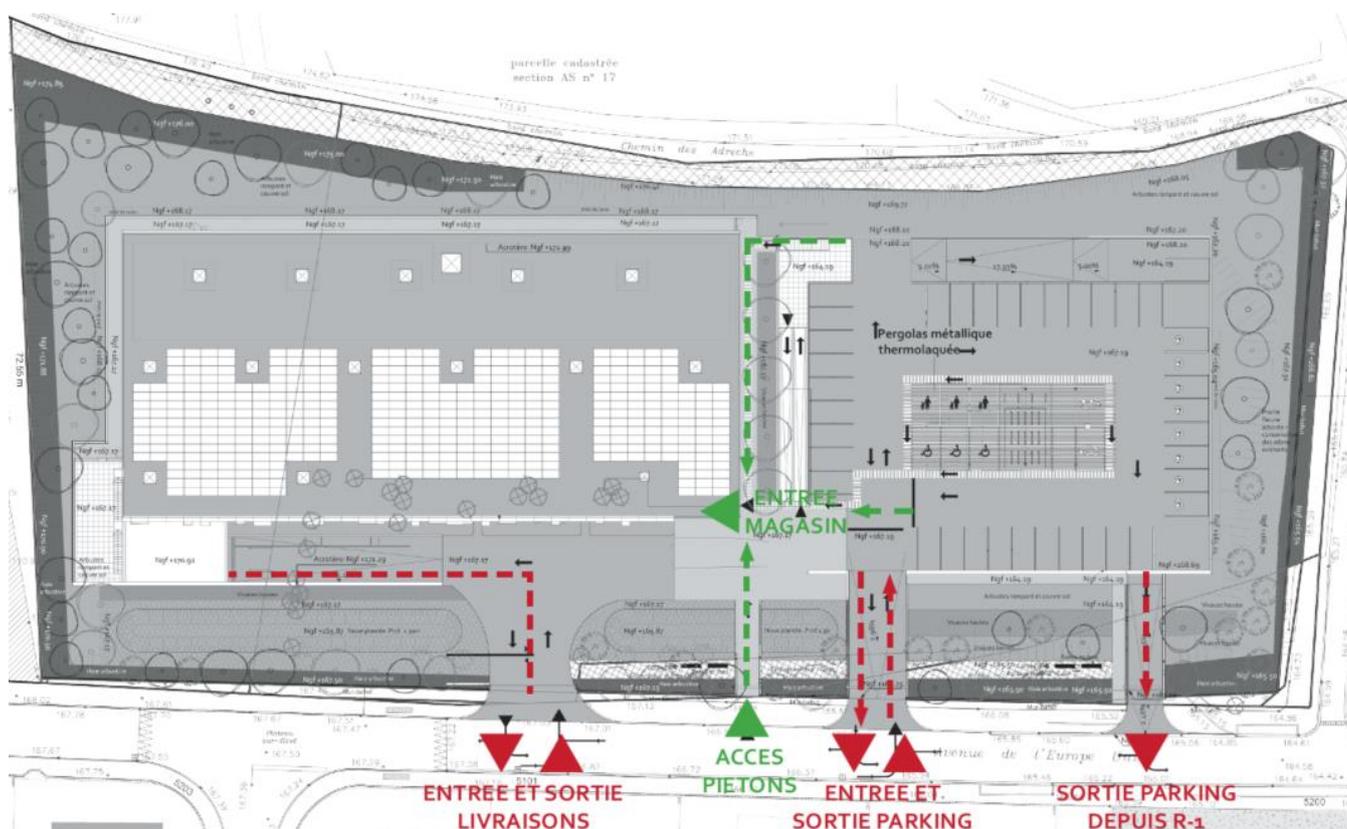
Plan des accès à la future surface commerciale depuis l'Avenue de la Libération (Source : Notice architecturale et paysagère – TANGRAM Architectes – 03/2021)
